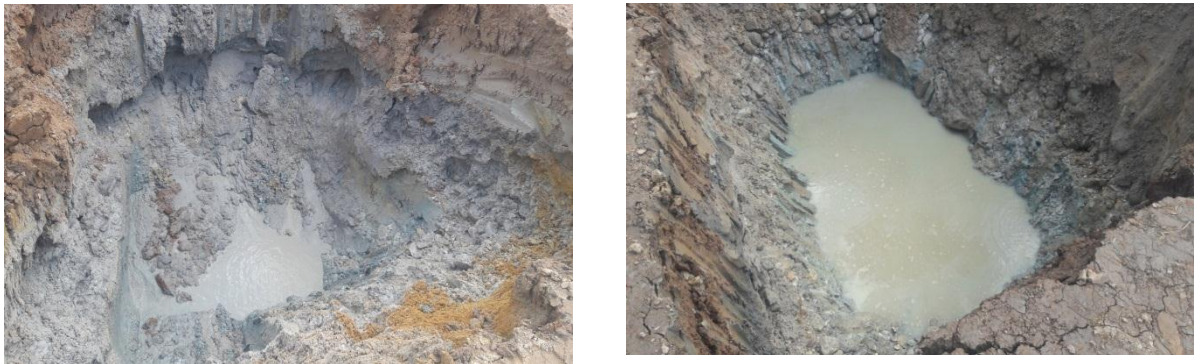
Sellamiento con el Vibro compactador de la caja MZ D
